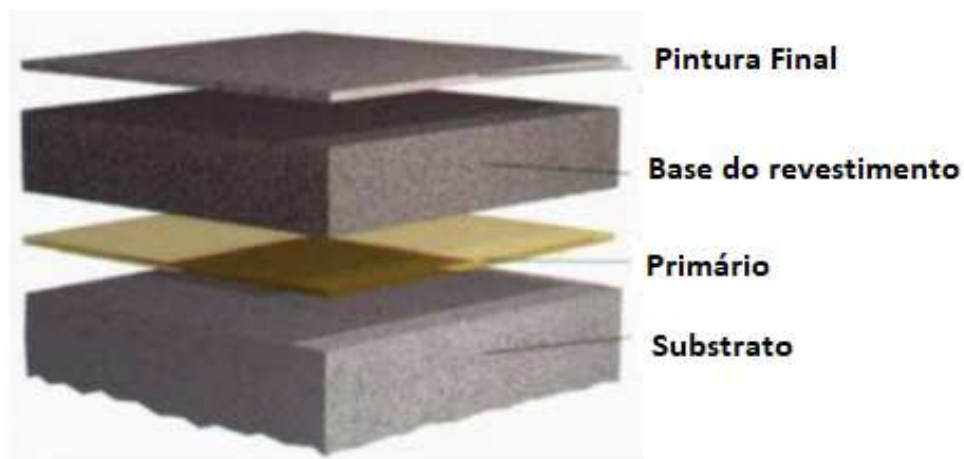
Camadas do revestimento de pavimento. [Adaptado de Stonhard (2018)]
